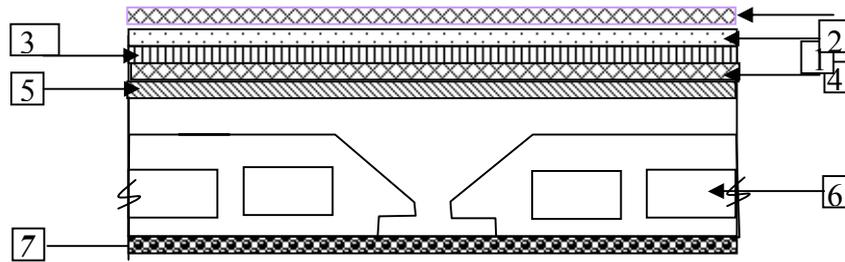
Coupe transversale d'un plancher terrasse inaccessible.
